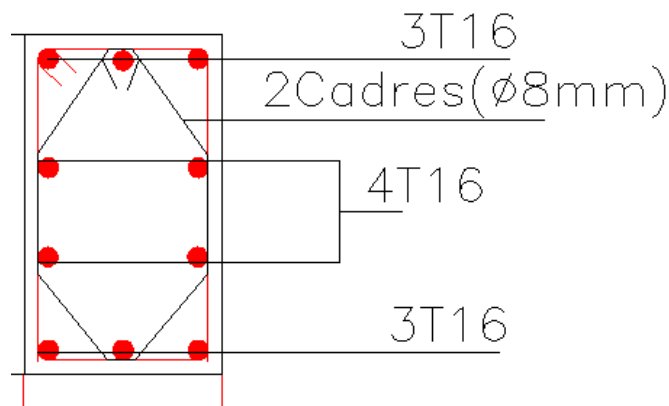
Schéma représentatif du ferrailage du poteau 35 × 60
